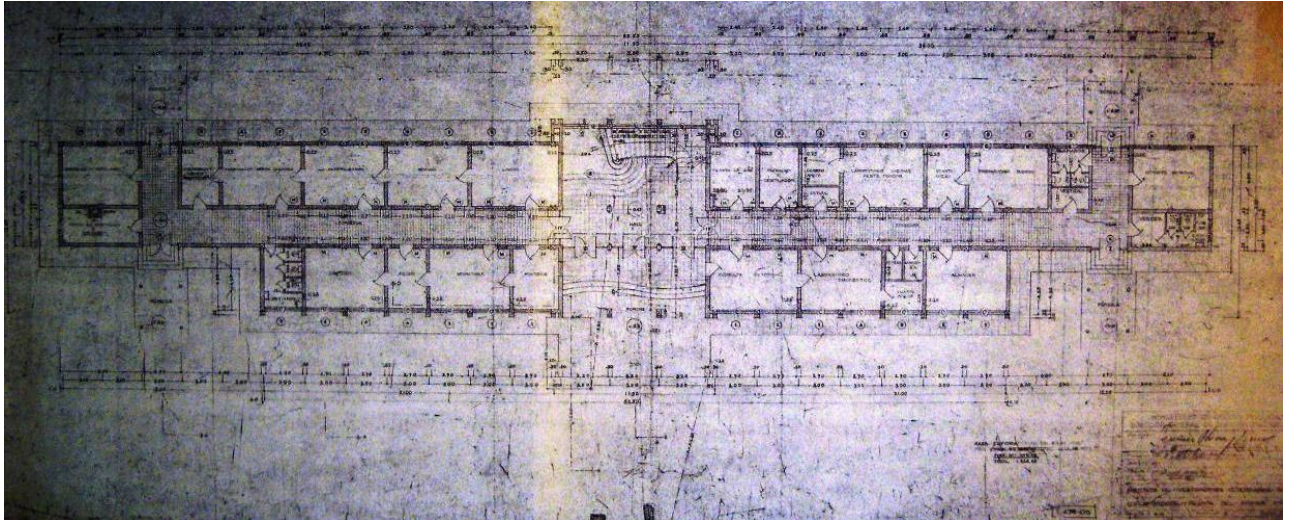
Grundriss des Erdgeschosses des Hauptgebäudes.
